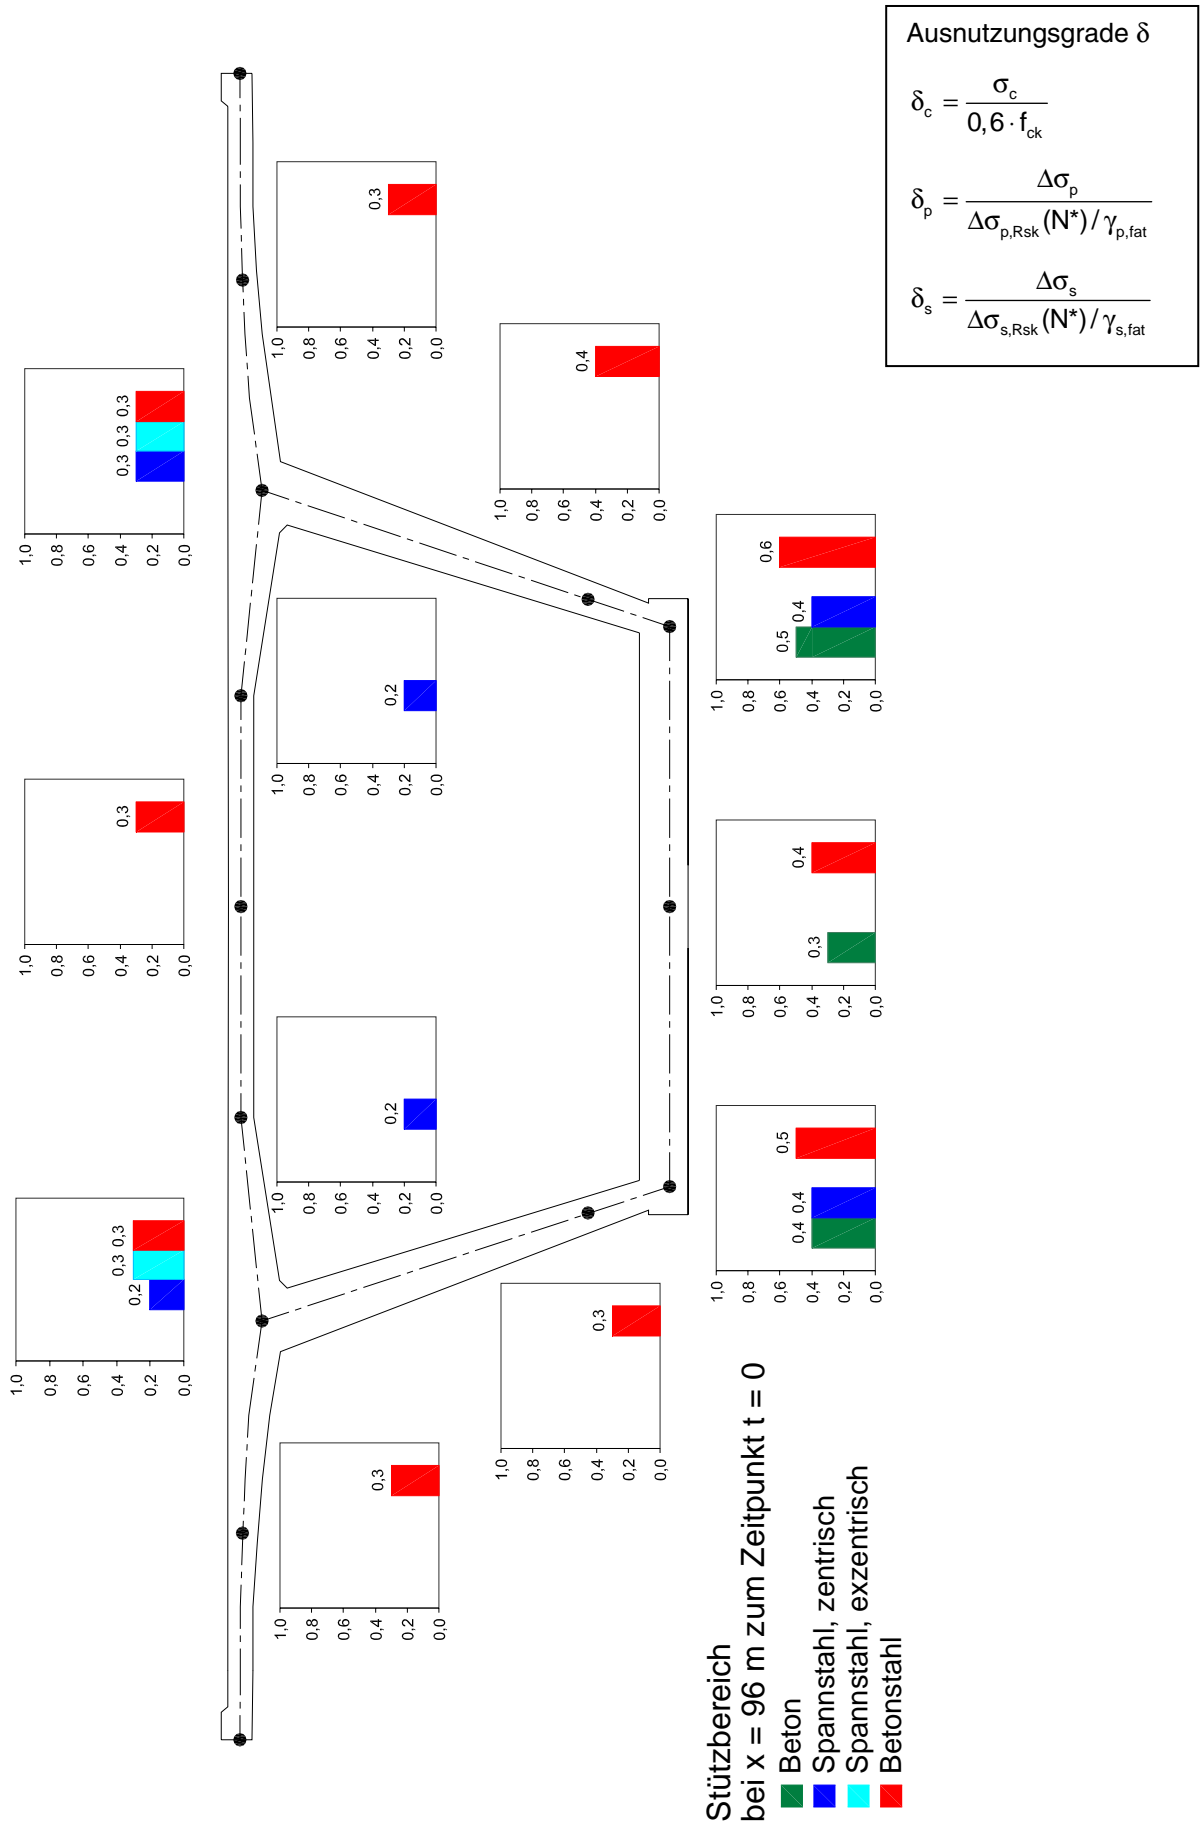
Ausnutzungsgrade des Betons δ_c , Spannstahls δ_p und Betonstahls δ_s
